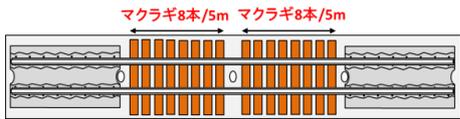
仮軌道及び緩衝マクラギ構造(平面図)
